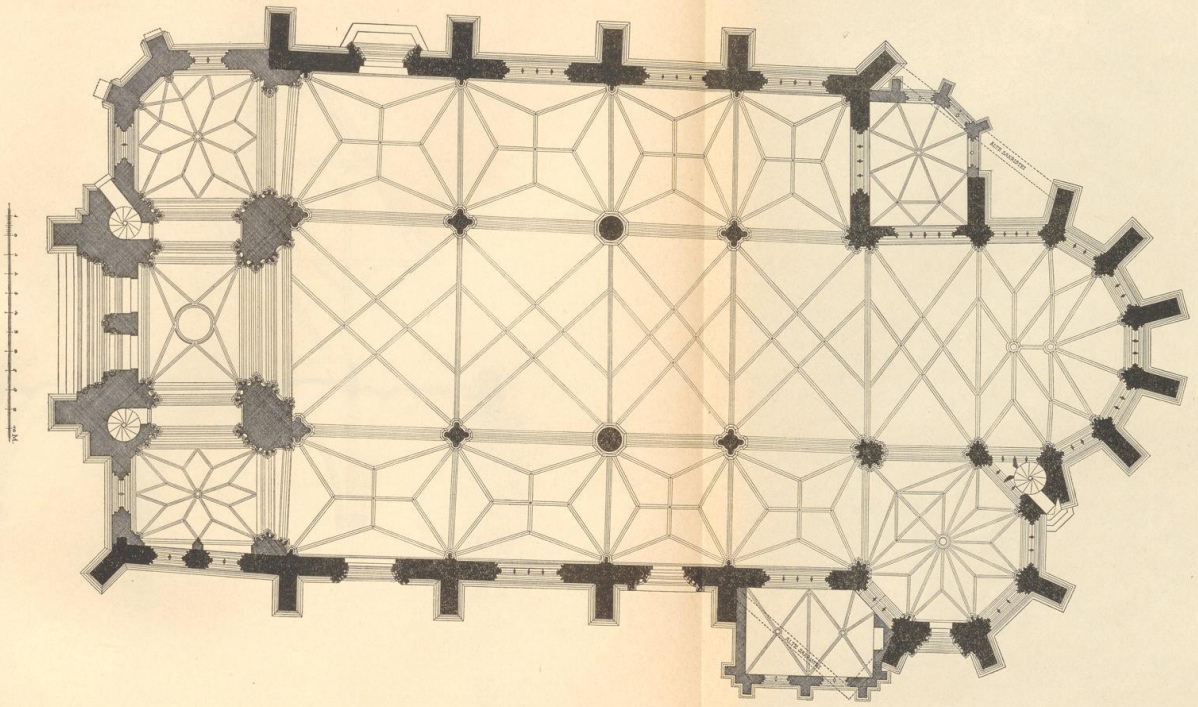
Der Grundriß der heutigen Lambertikirche mit dem neuen Turm. Maßstab 1 : 200
